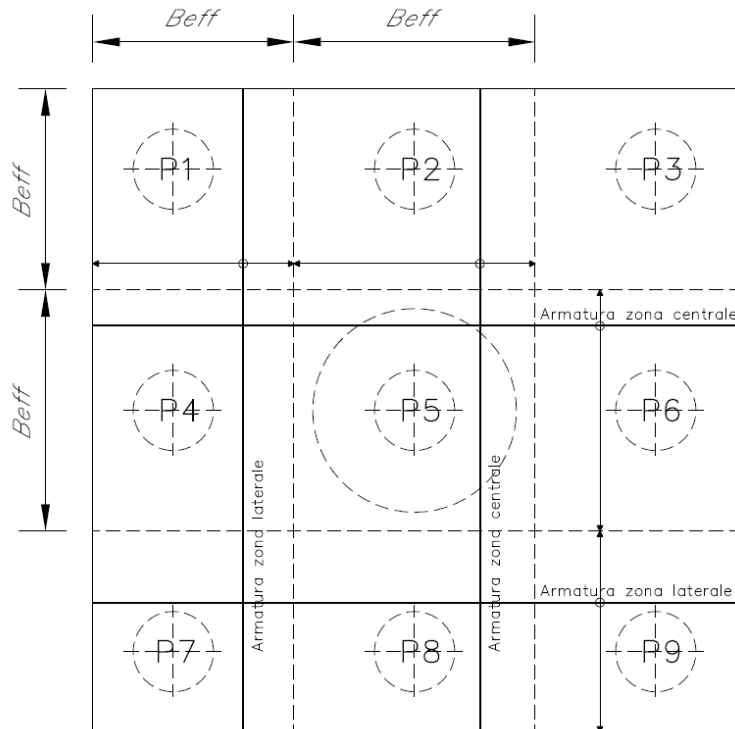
Plinto di fondazione – Armatura longitudinale inferiore e superiore
